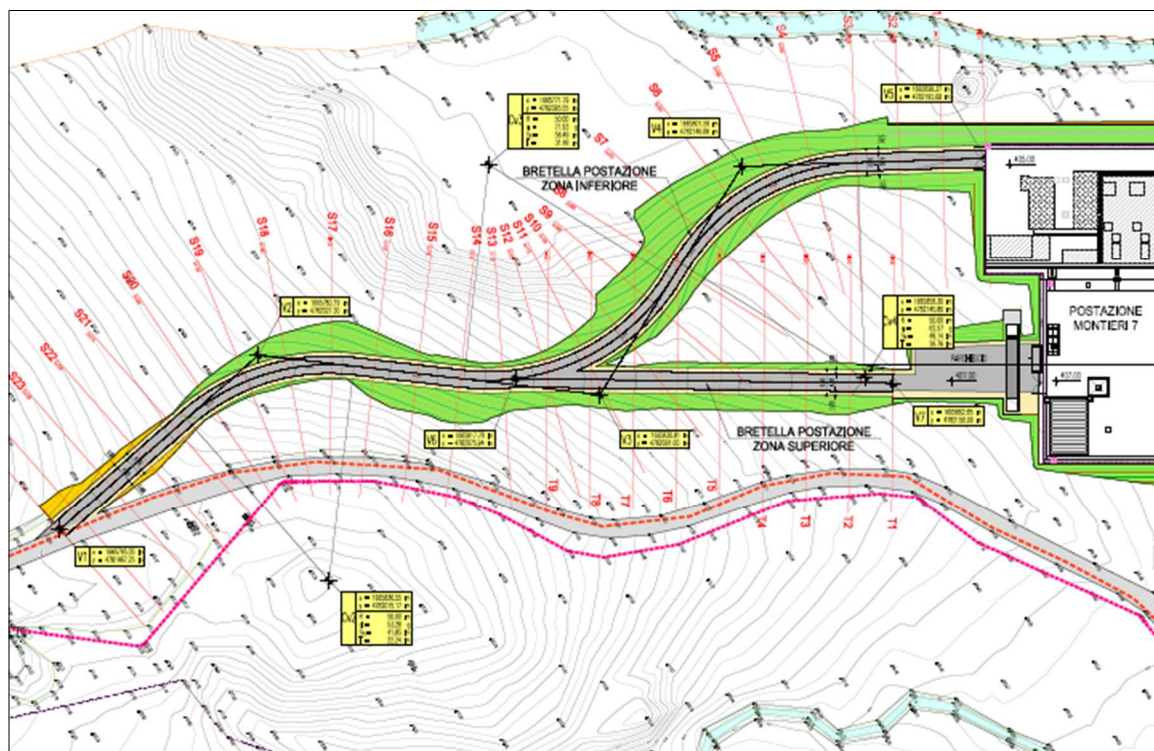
Planimetria delle bretelle di accesso e parcheggio.
